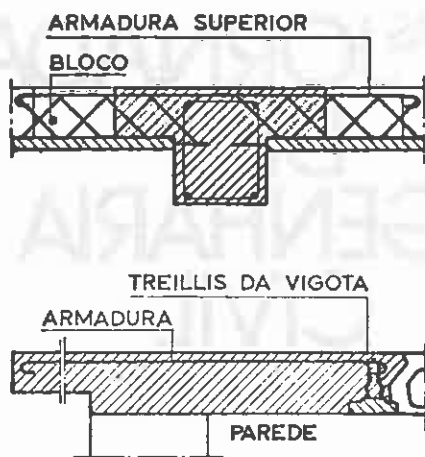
Vigotas de betão armado: pormenores de apoio
